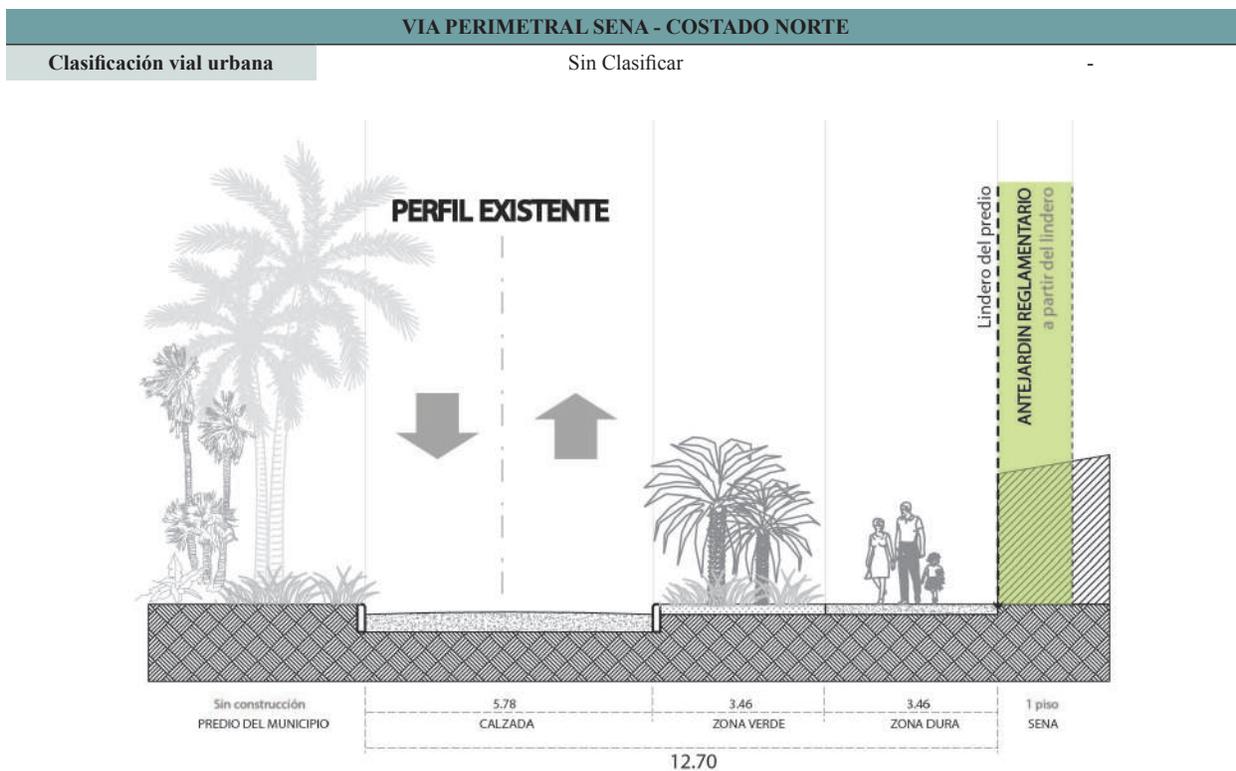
Perfil vial Vía Perimetral costado norte.
